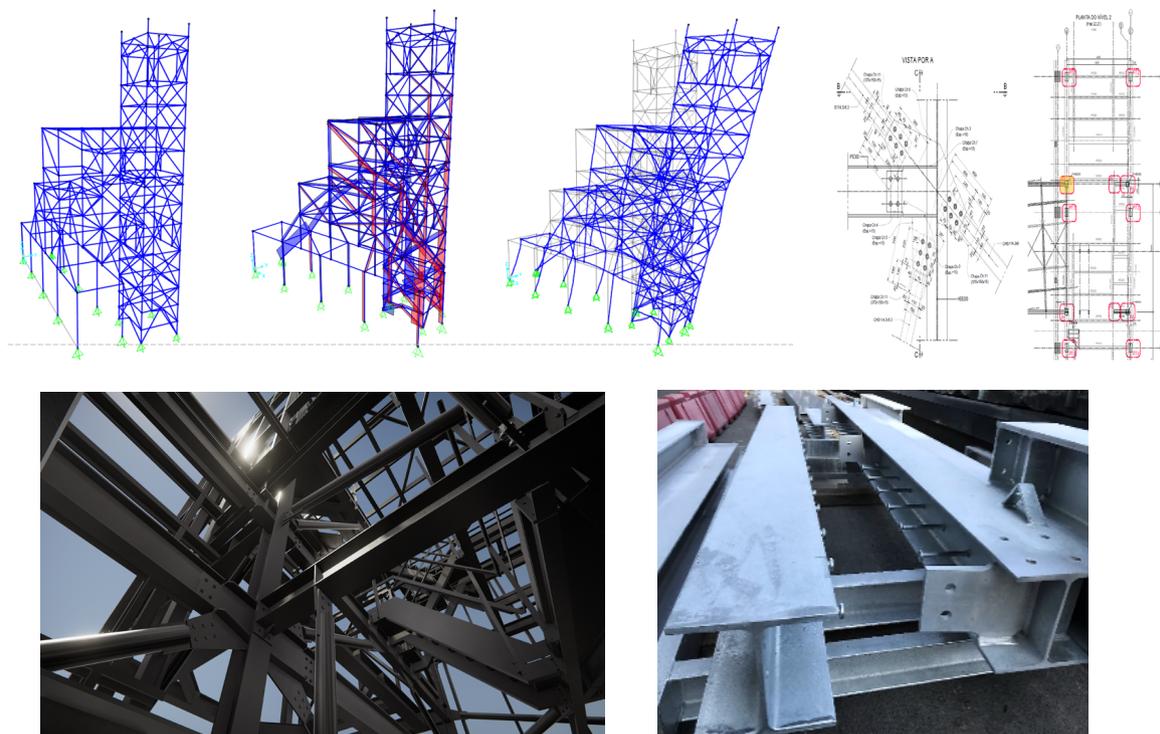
Modelos de cálculo, esforços e deformadas; Extração de peças desenhadas do modelo diretamente do modelo; aspeto do modelo 3D, a partir do qual foi possível a coordenação do trabalho; elementos da estrutura metálica, executados nas instalações da Metalomecânica da Teixeira Duarte a partir do modelo TEKLA.
